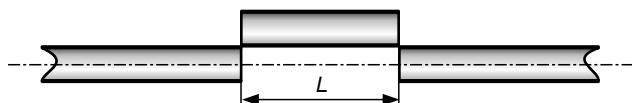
Схема врезки в трубопровод при установке расходомера
